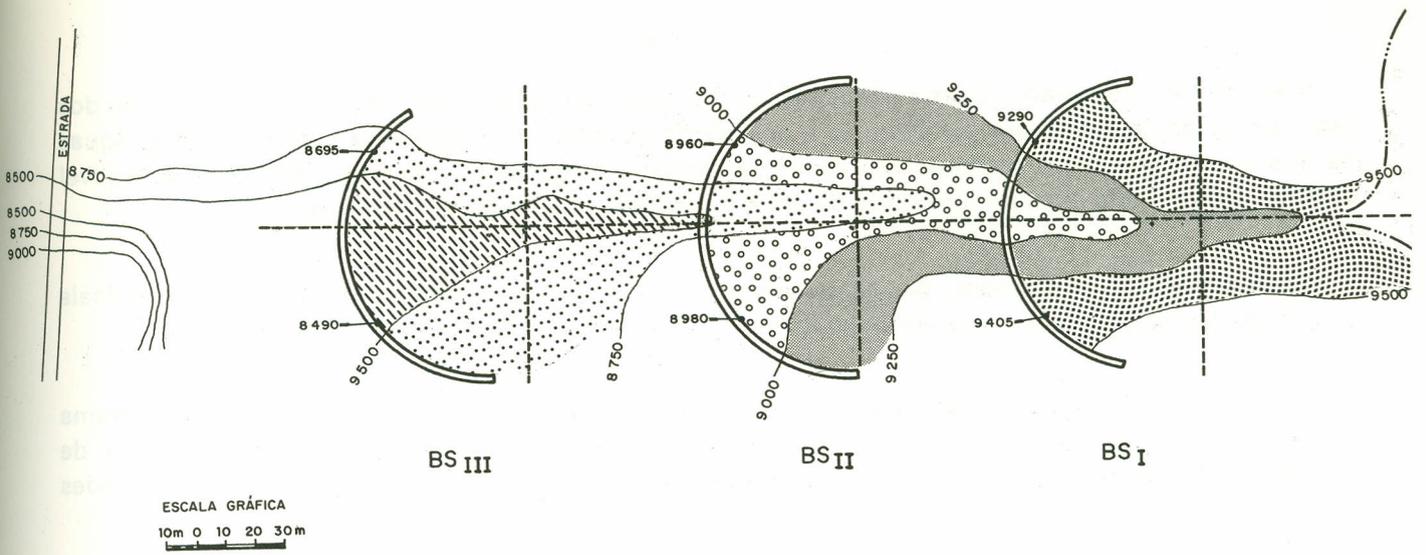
Planta planialtimétrica das barragens subterrâneas tipo CPATSA (SAES-BS).
